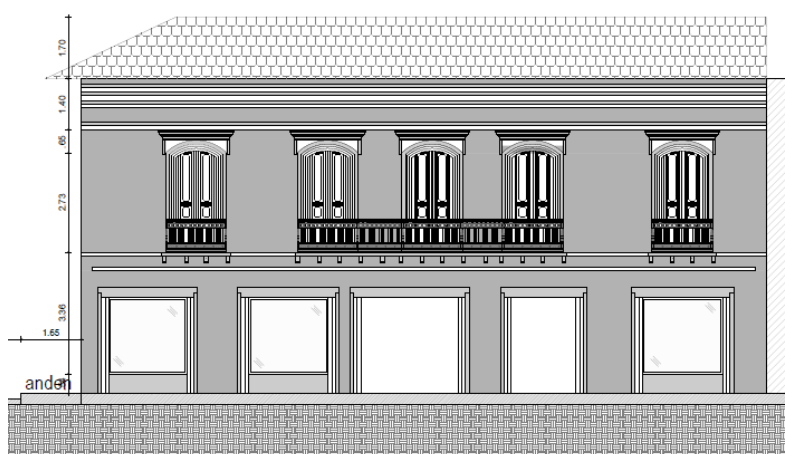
Fachada Propuesta calle 18. Fuente: Propia
